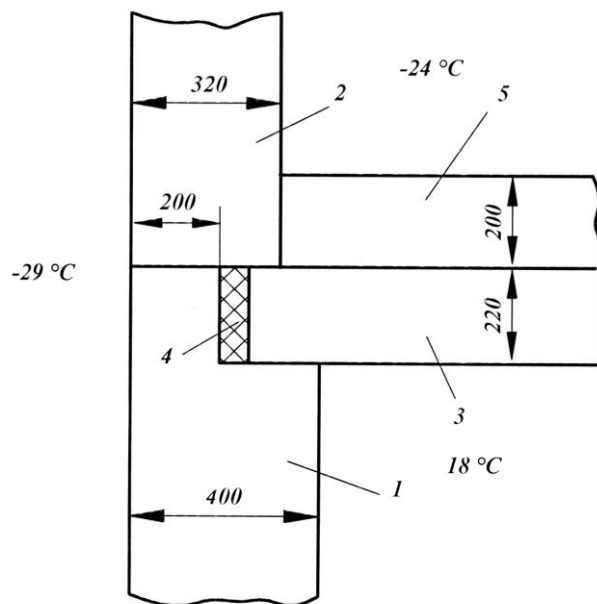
Схема карнизного вузла: 1 – стіна з керамзитобетонних блоків; 2 – фризівний блок із шлакобетону; 3 – багатопорожнинне горіщне перекриття; 4 – мінеральна вата; 5 – шлакова засипка
